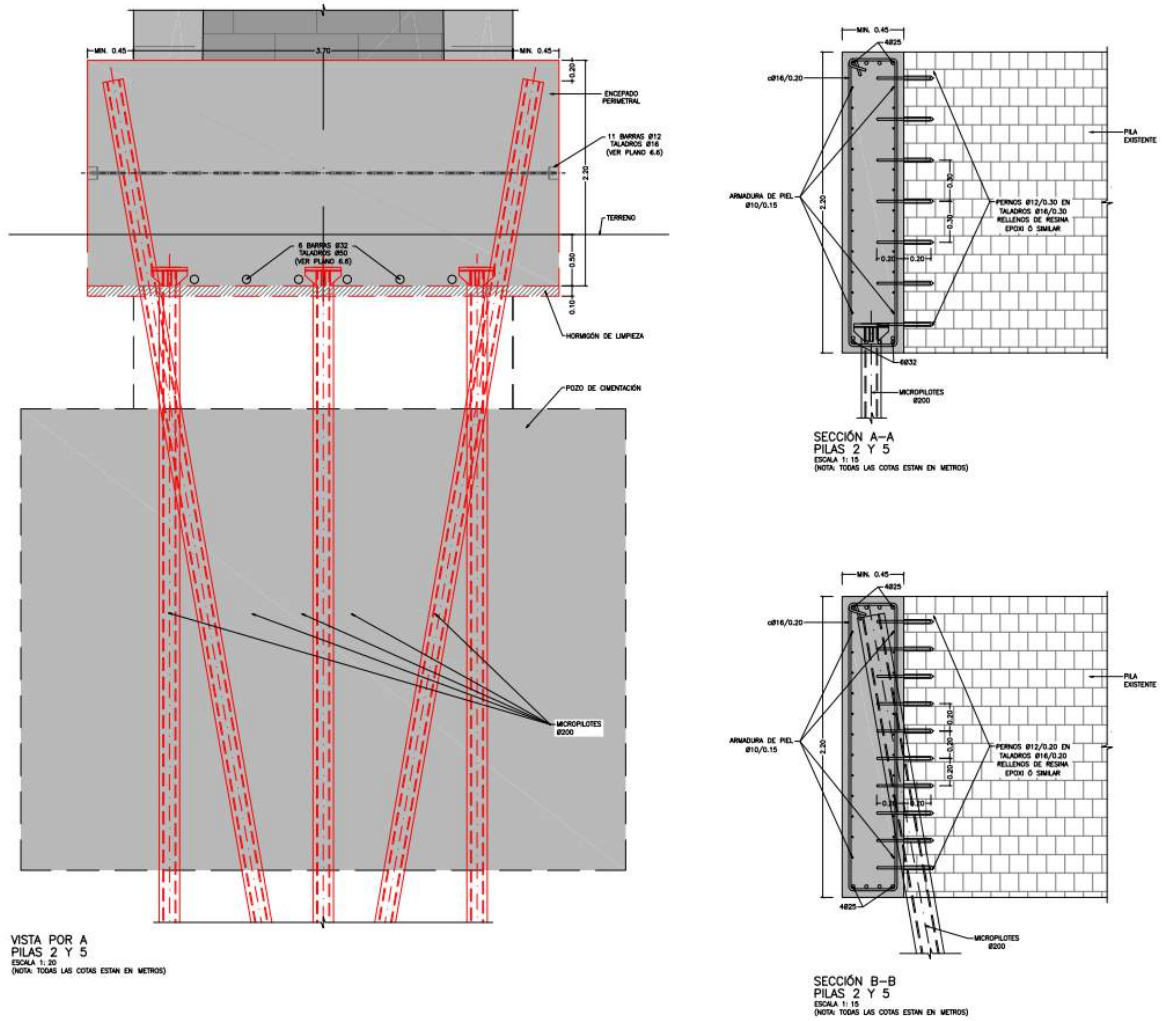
Alzado y secciones transversales con la situación de los micropilotes de las pilas P-2 y P-5, junto con el encepado perimetral
